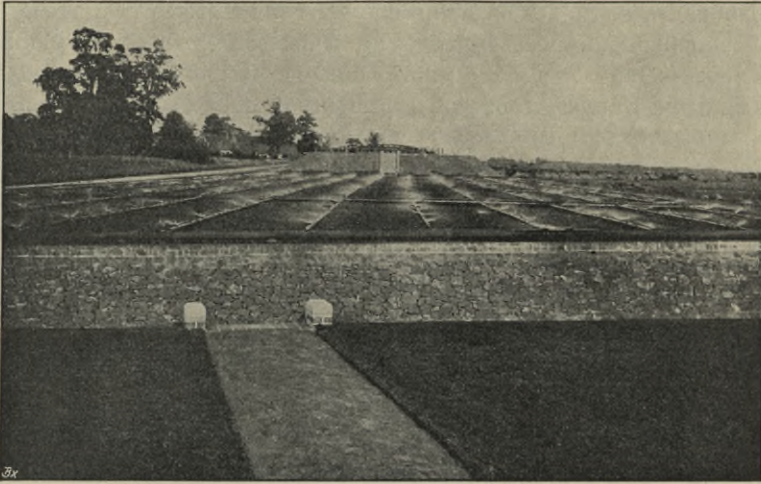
Tropfkörper aus Steinschlag mit Abwasser-Versprüher in Birmingham.
